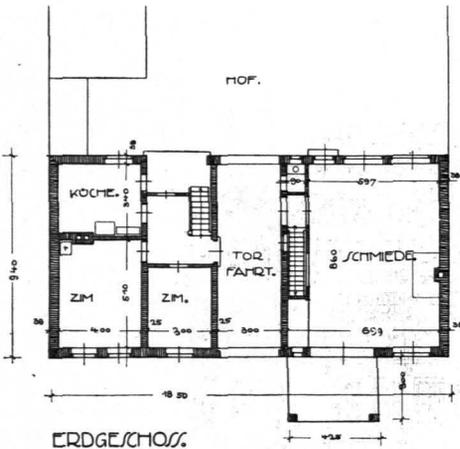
ANSICHTEN UND GRUNDRISSSE. (M. 1:365.)
